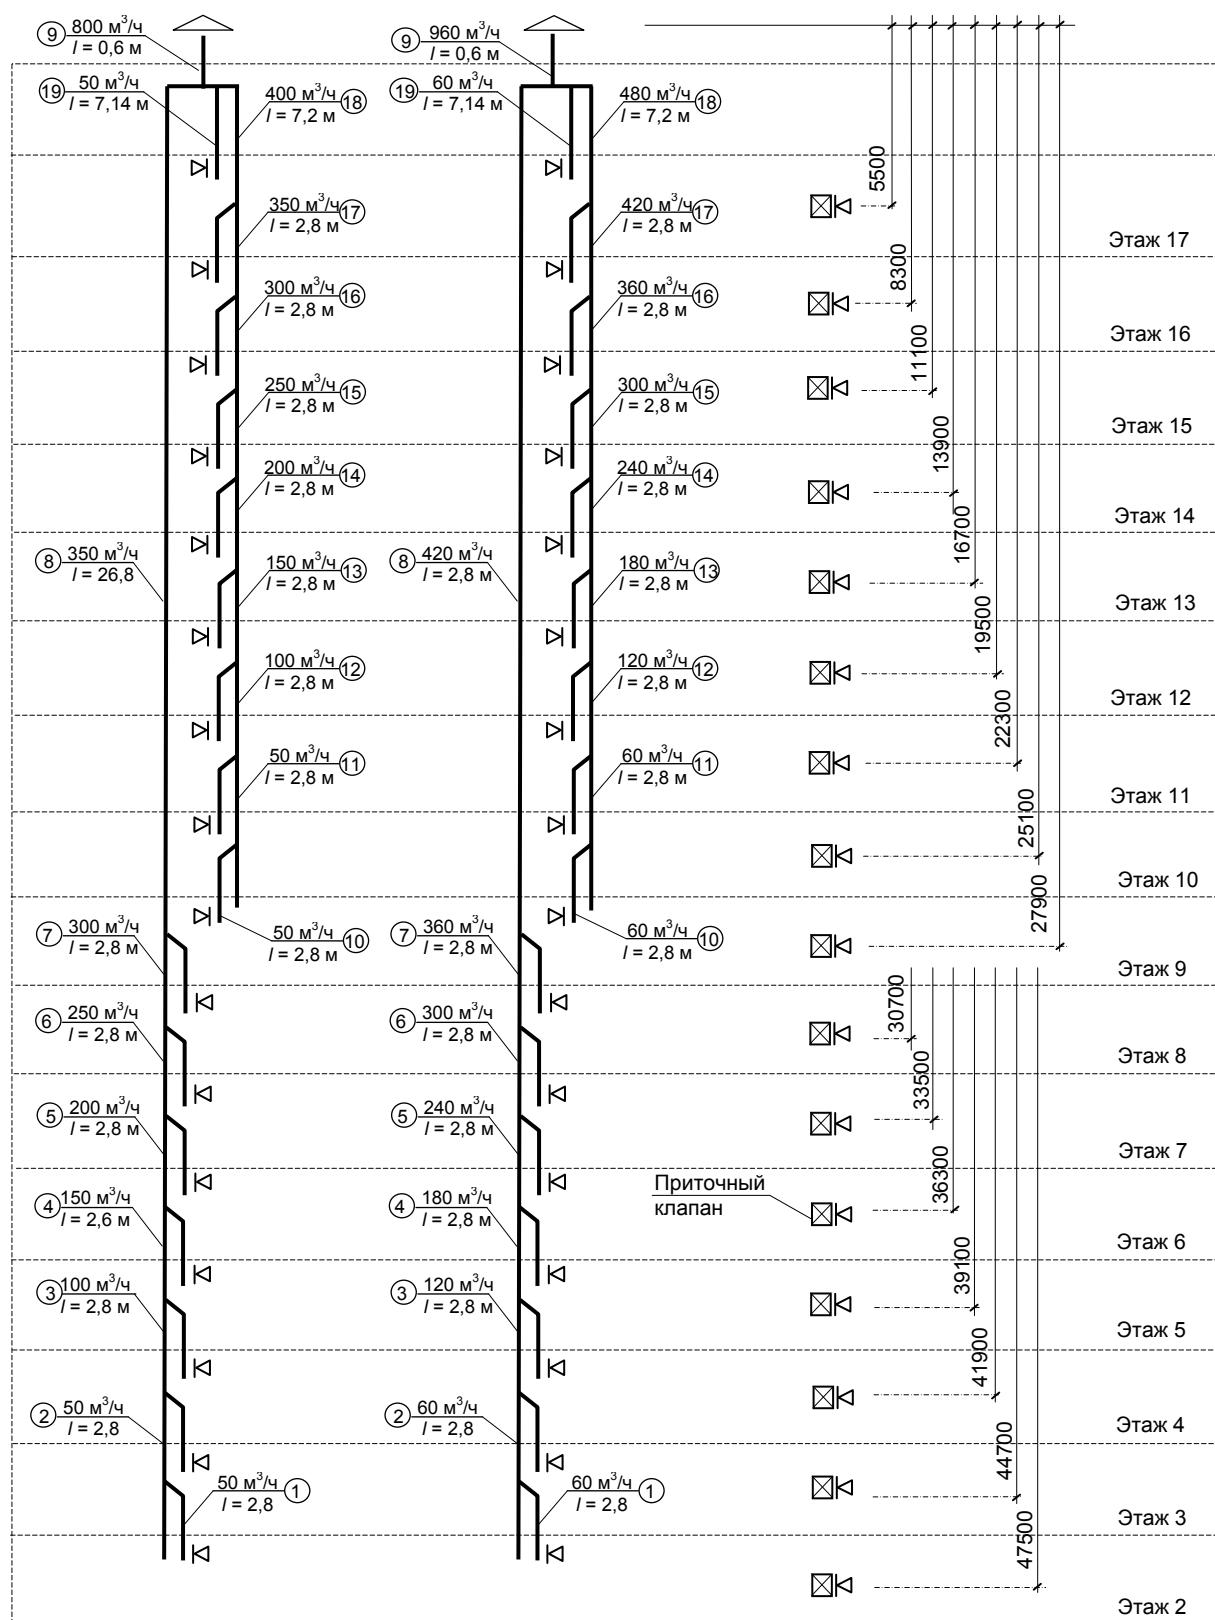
Расчетные схемы систем вентиляции ВЕ-1 и ВЕ-2
